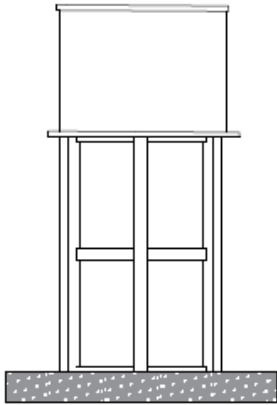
Alçado do sistema estrutural em análise (sem escala)
